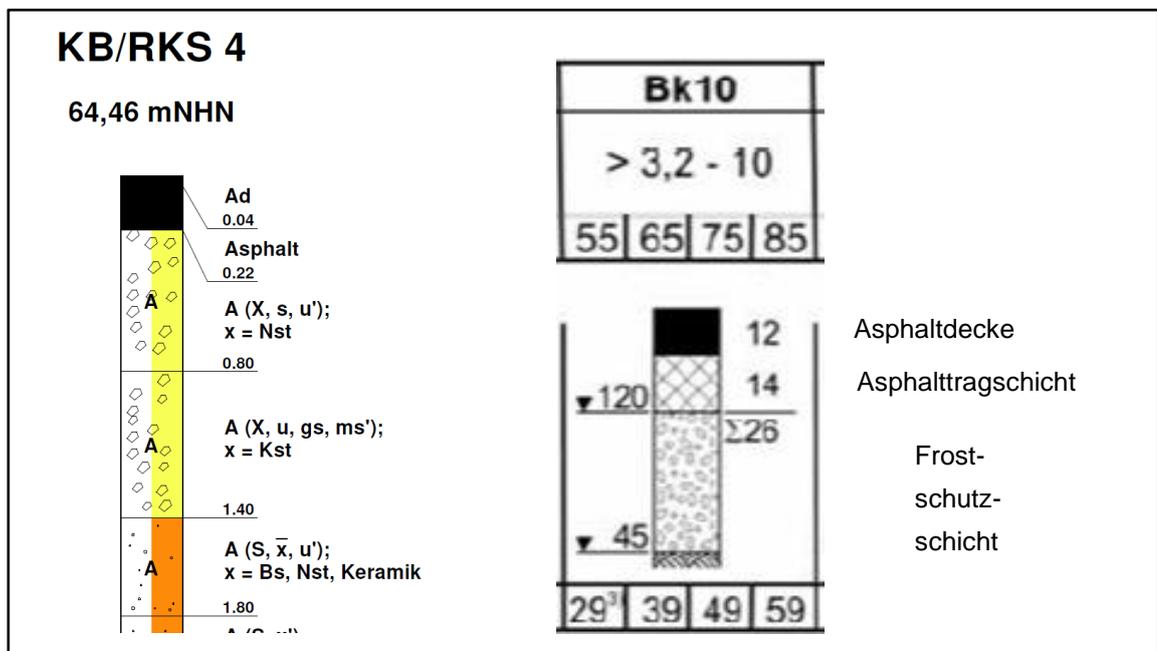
Bohrprofil 4 gemäß Baugrundgutachten (Links) und Aufbau gemäß RStO 12 [1] (Rechts)
